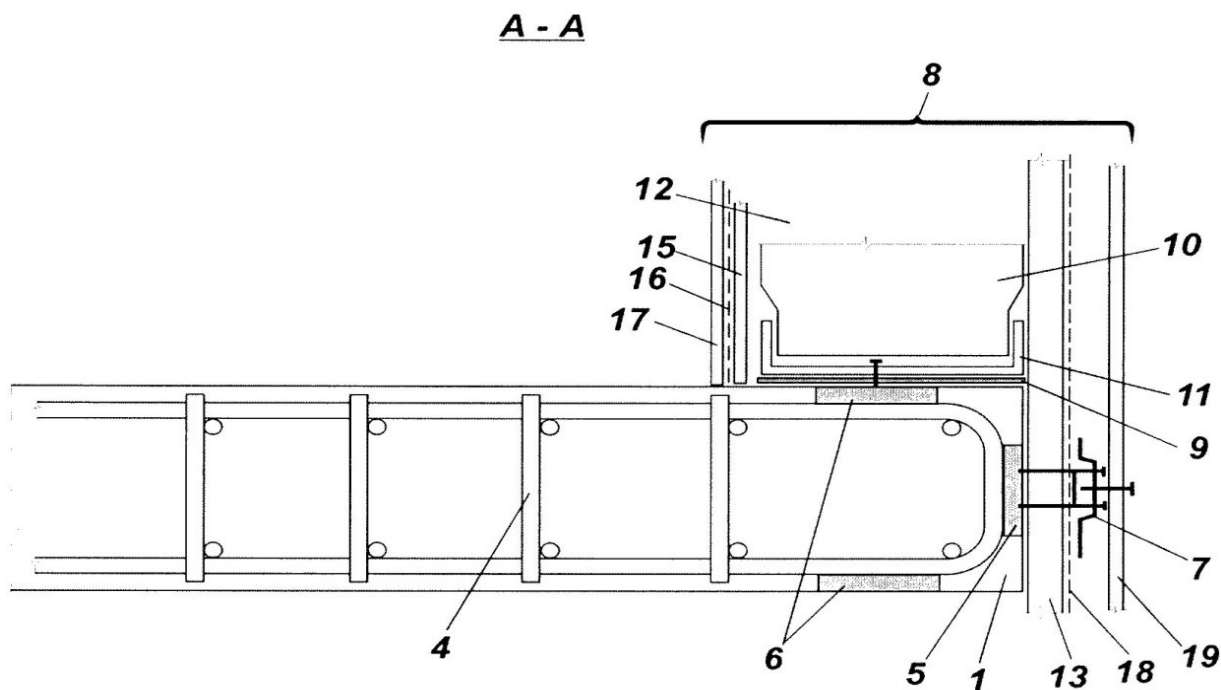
Сечение А-А фрагмента плана размещения на плите перекрытия здания самонесущей ограждающей многослойной стены [2]:
